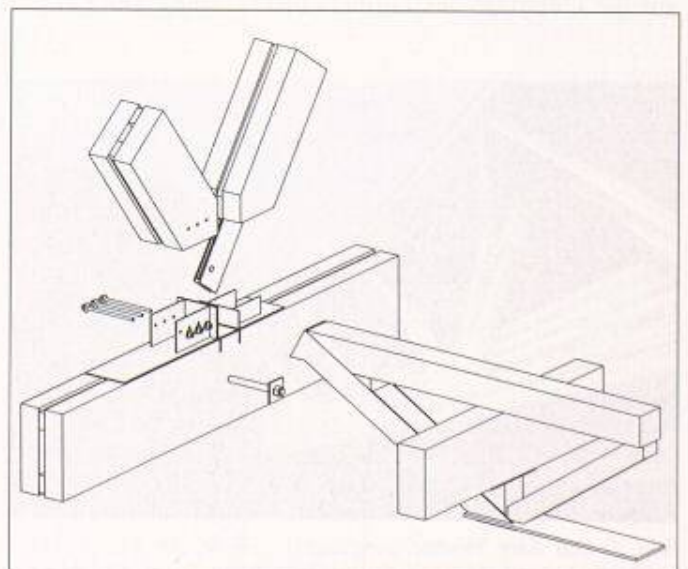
Explosionszeichnung eines Untergurtnotens mit Querträger
